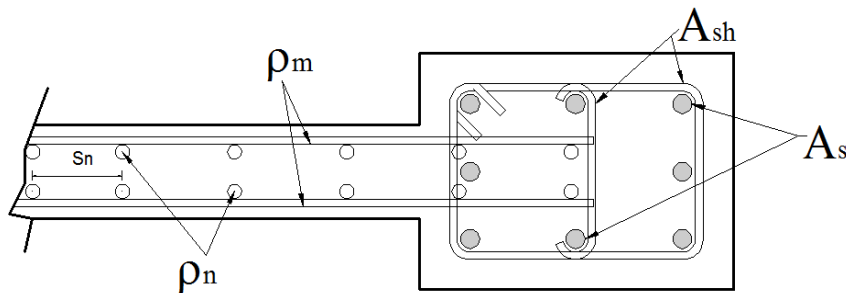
5 Refuerzo longitudinal y transversal en muros
